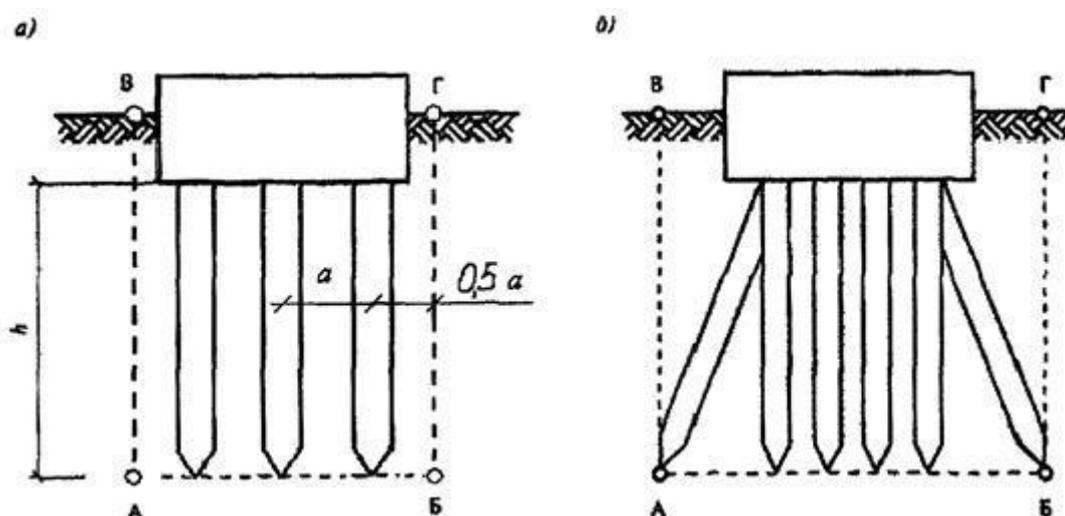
Определение границ условного фундамента при расчете свайных фундаментов
